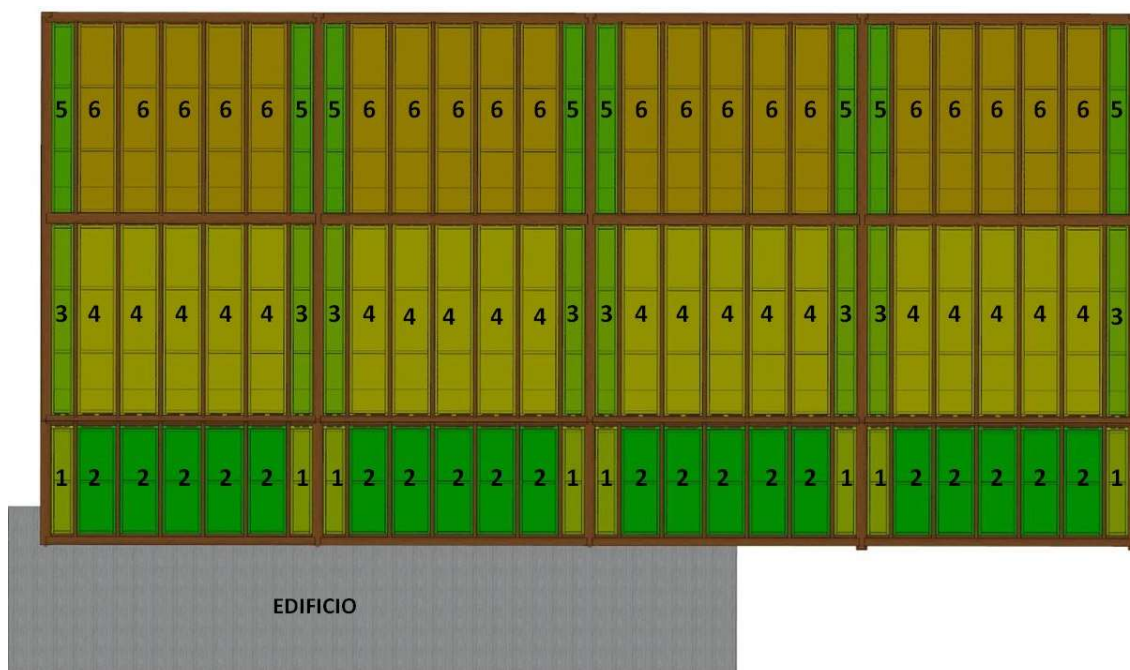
Distribución de módulos de cubierta. Imagen de Cadwork.
